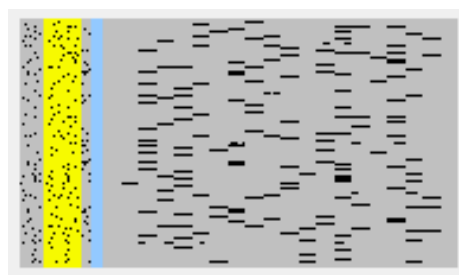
Vista de la secció de façana amb el sistema modular instal·lat.
